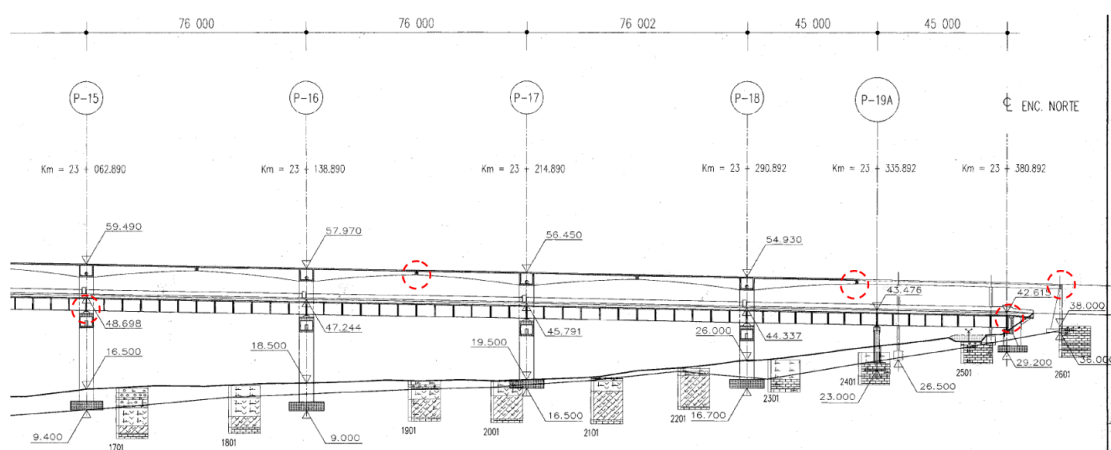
Localização das juntas dos tabuleiros rodoviário e ferroviários, mais próximas da zona de intervenção, assinaladas a vermelho (Peça desenhada N°76 do Projeto de Execução – Instalação da via férrea no viaduto de acesso norte à ponte sobre o Rio Tejo em Lisboa)
